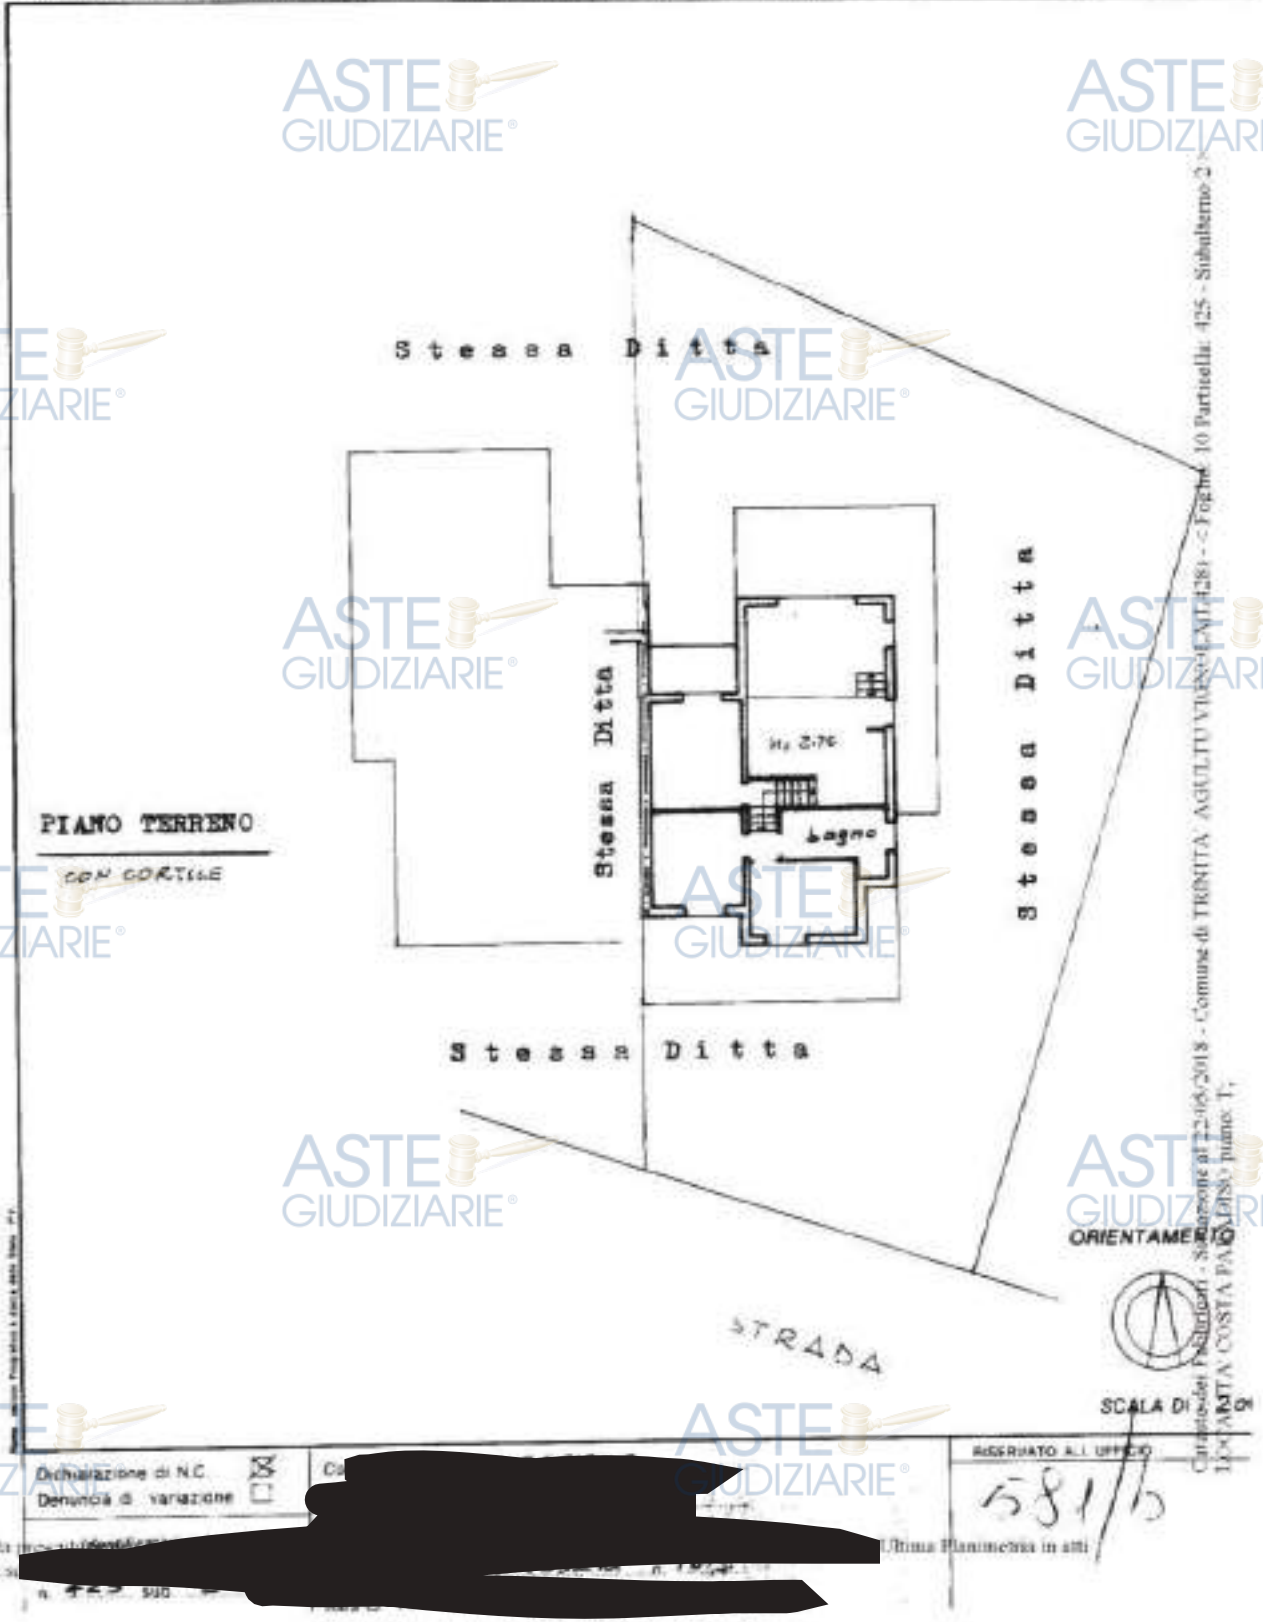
Visura planimetrica catastale originaria Fig. 10 Part. 425 Sub 2 (soppresso)
